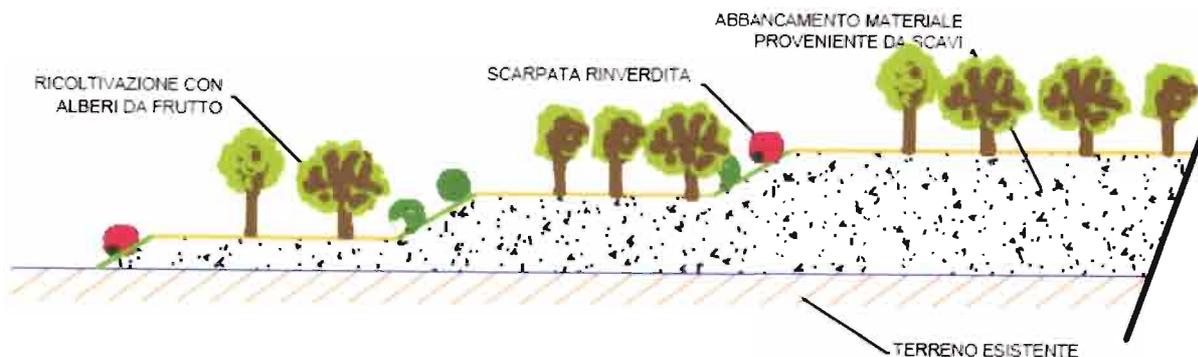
Sezione tipo per ricoltivazione alberi da frutto, presso il deposito Plattner.
